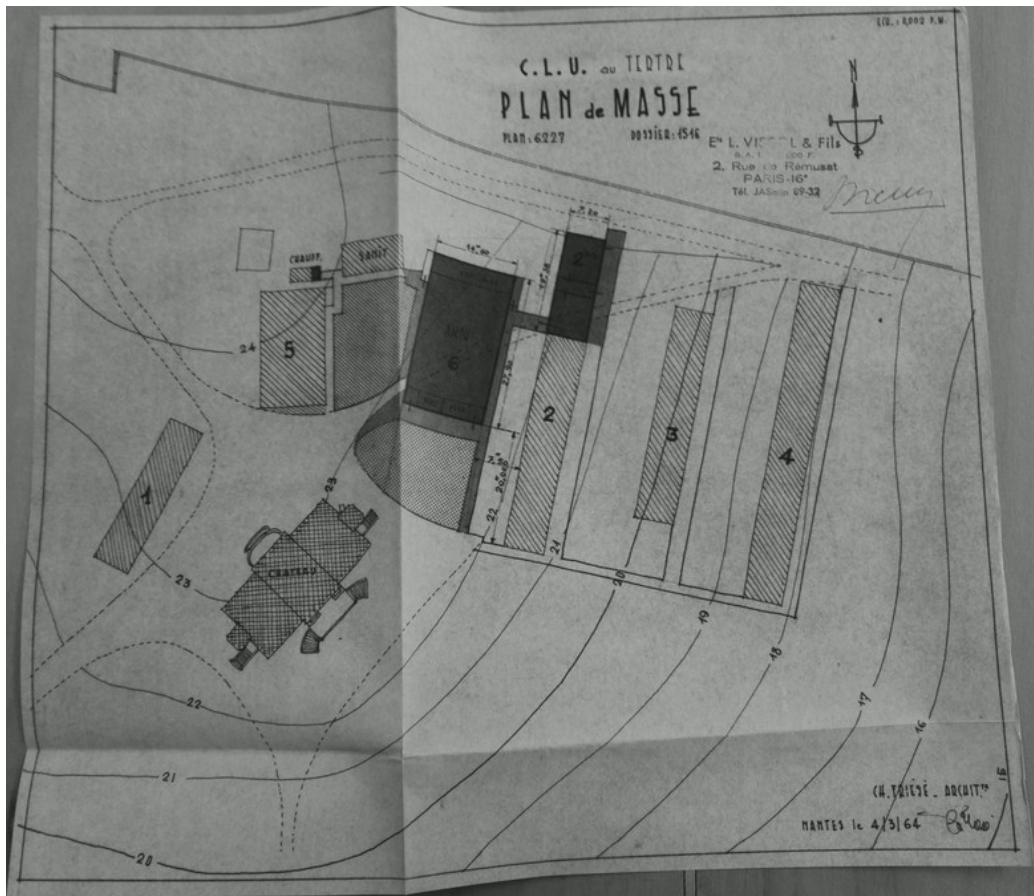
Plan de masse du Collège Littéraire Universitaire du Tertre. Louis Arretche et Charles Friésé. 4 mars 1964. ADLA1078W33
